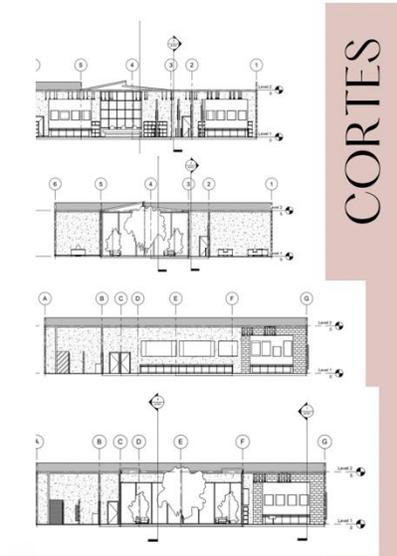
Planos en Archicad. Fuente: Ortiz Martínez (26).
